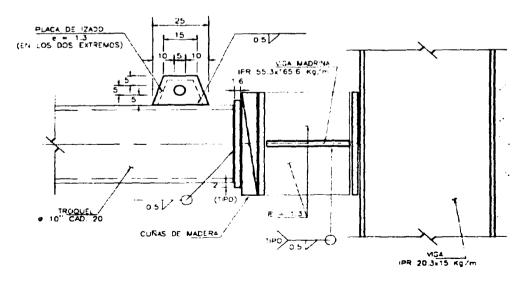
38 ESPECIFICACIONES REQUERIDAS EN LOS DETALLES DE LA FIGURA 5.37
